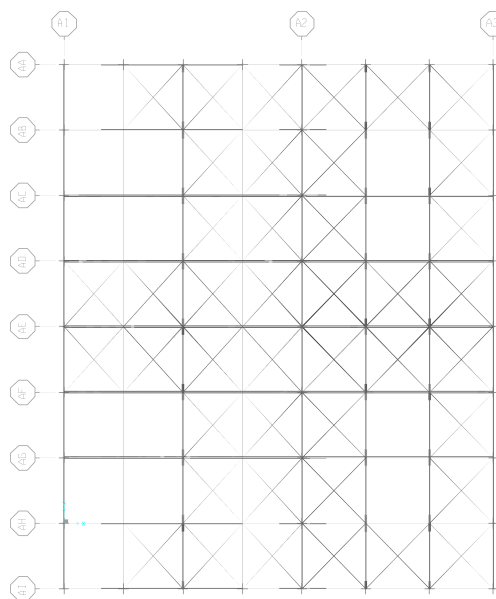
Vista en planta del techo de la estructura en SAP2000 V19
